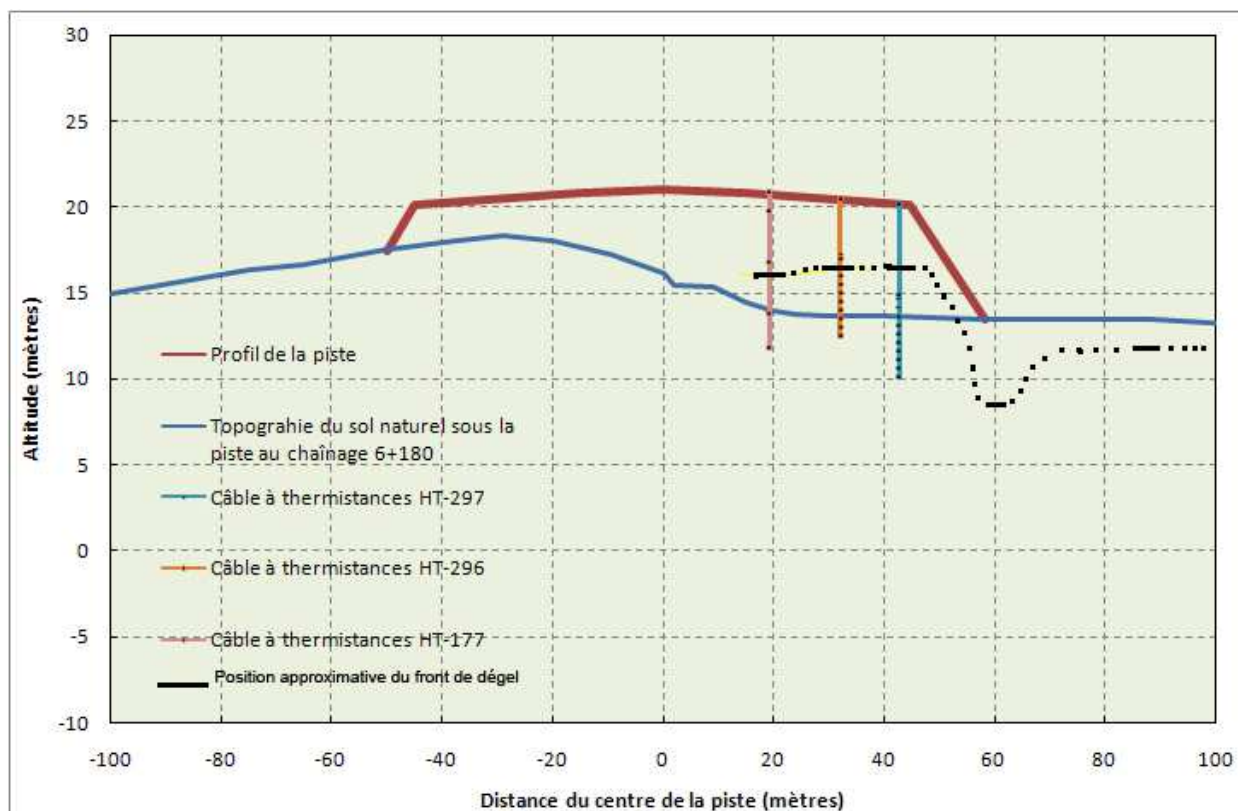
Coupe transversale de la piste avec puits instrumentés à Puvirnituk en 2008.
